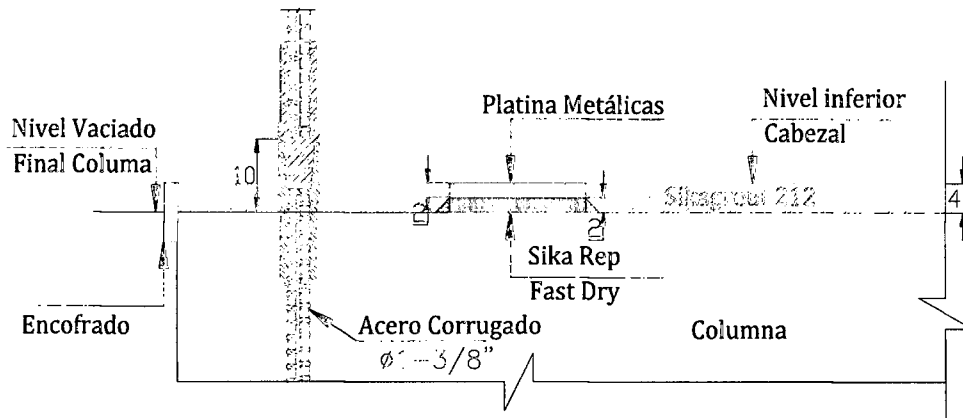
Esquema en elevación de ubicación de platinas de apoyo en la columna.
